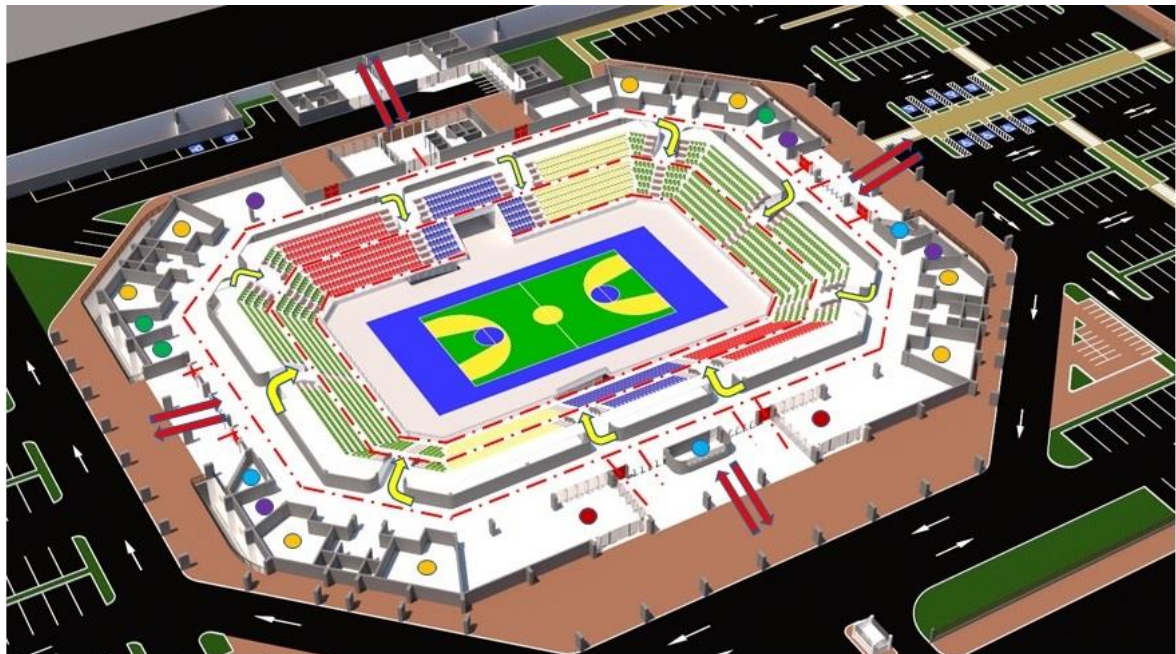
Planta baixa 1º pavimento subterrâneo bloco A (arena).
